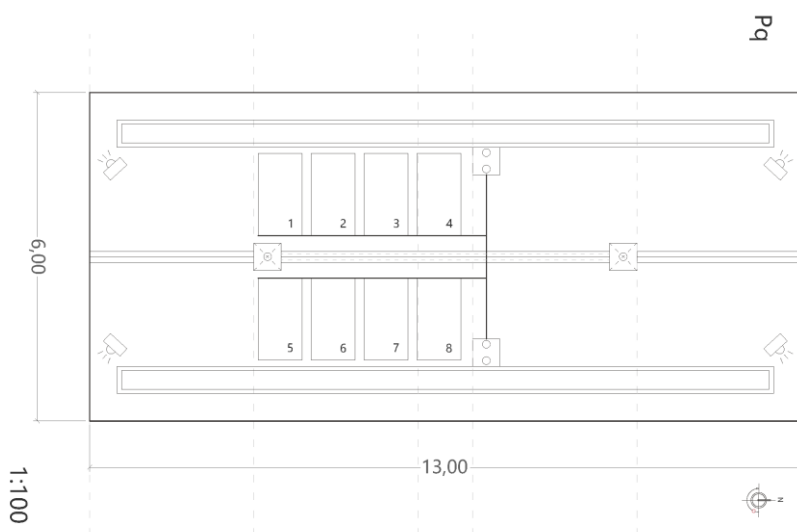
Prototipo Bm.2 (69,76 metros cuadrados construidos) : planta baja, planta
